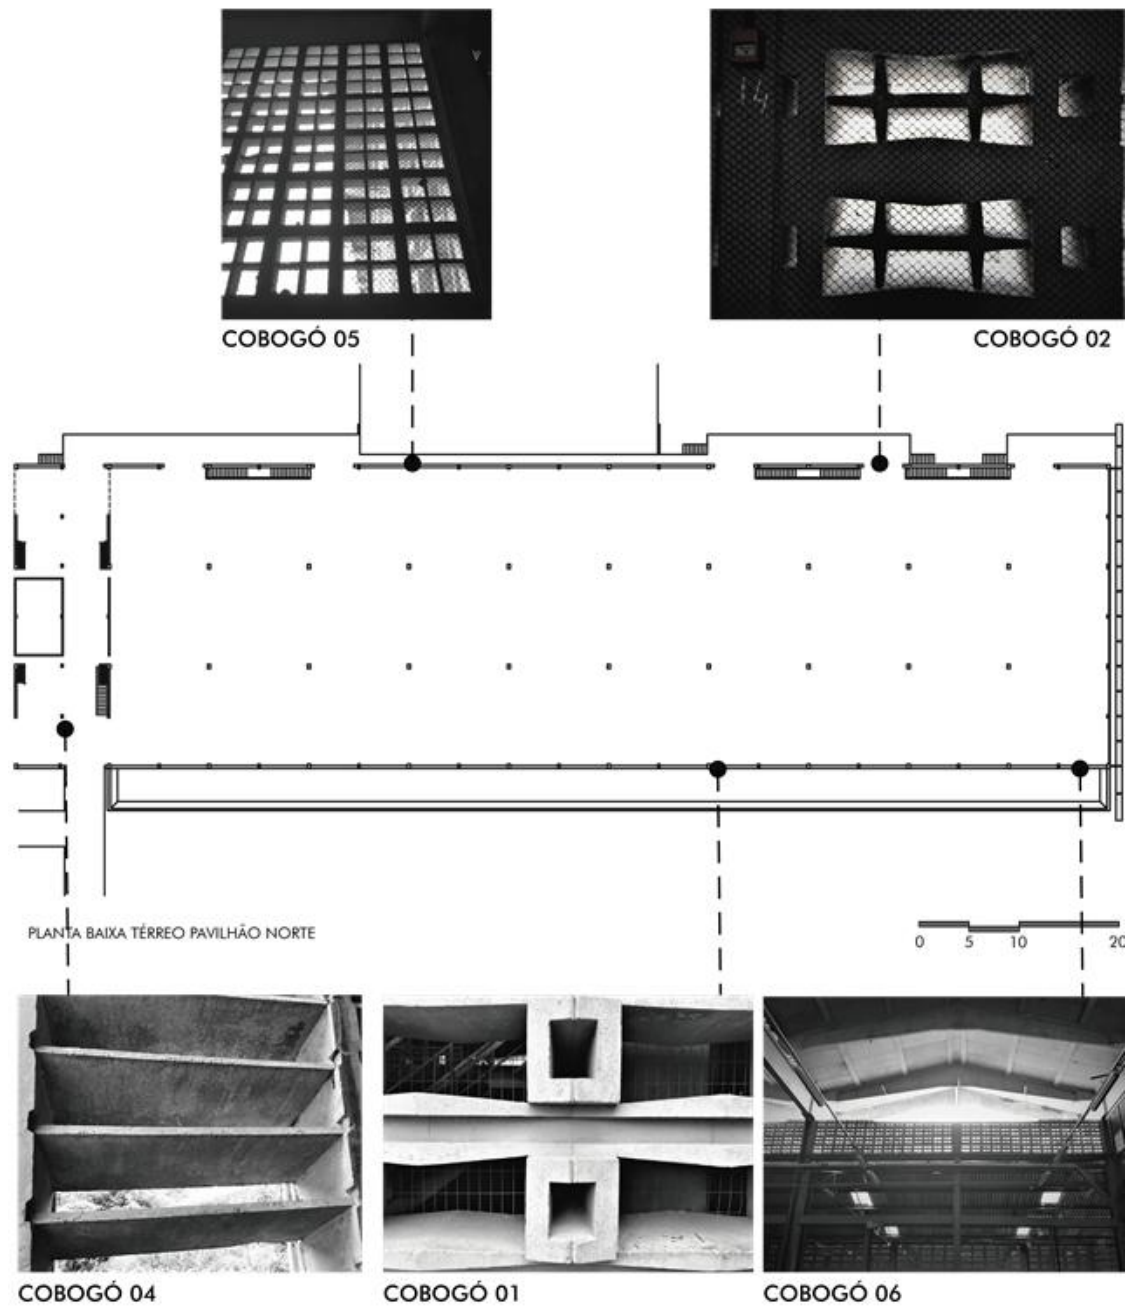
Localização dos cobogós em Planta do Pavilhão Norte
